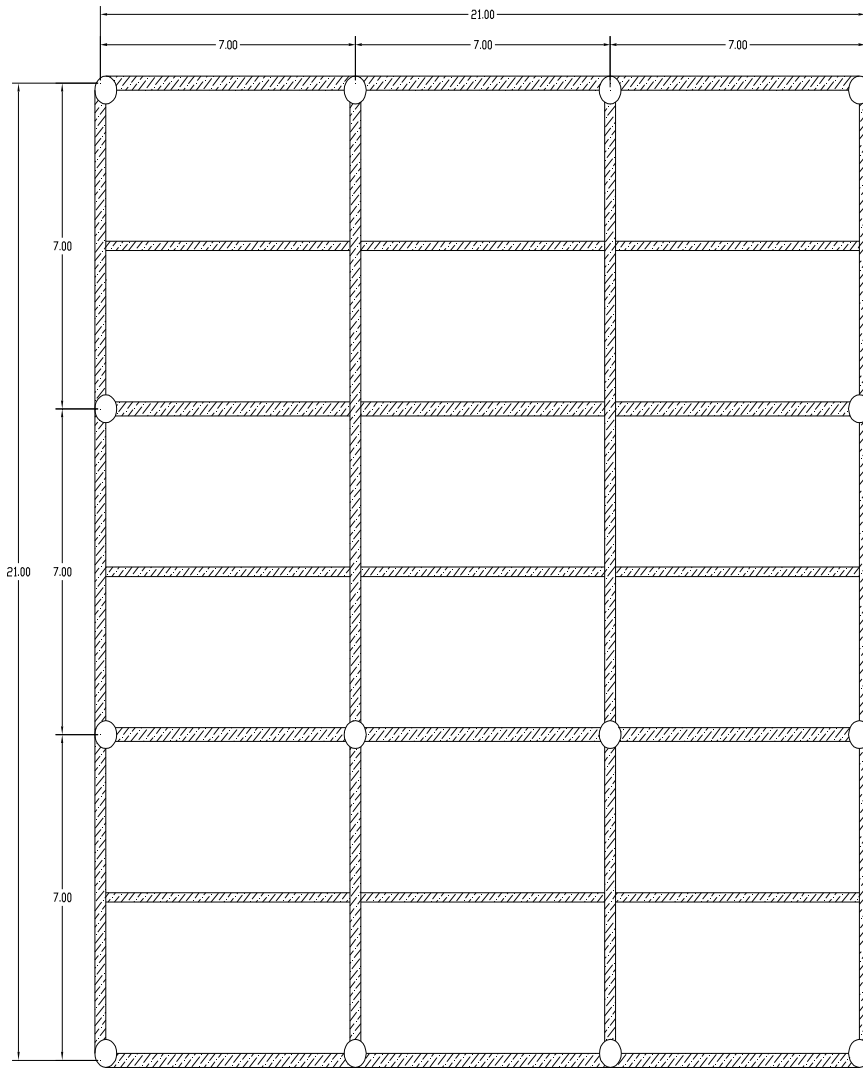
Tampak Samping Kiri Pelat Lantai
